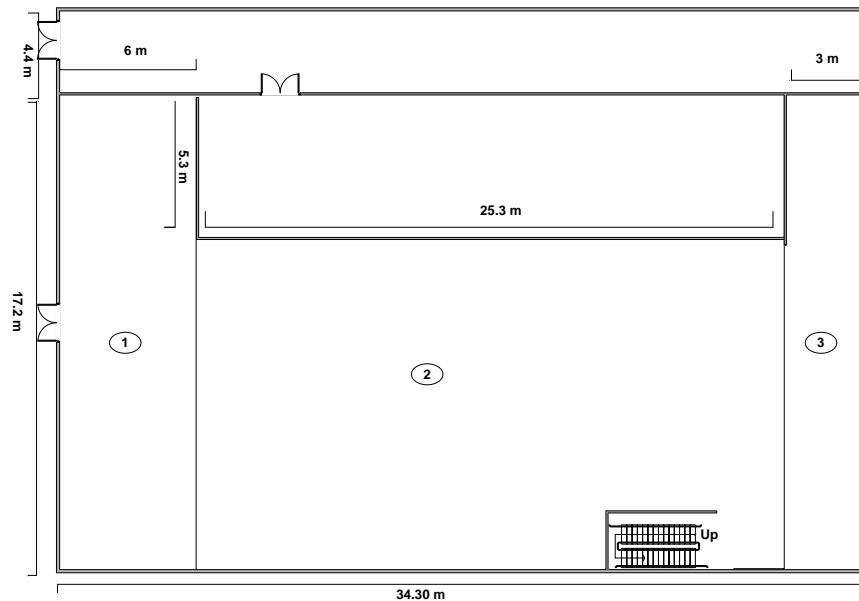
Plano de la planta de ensamblaje, primer nivel
